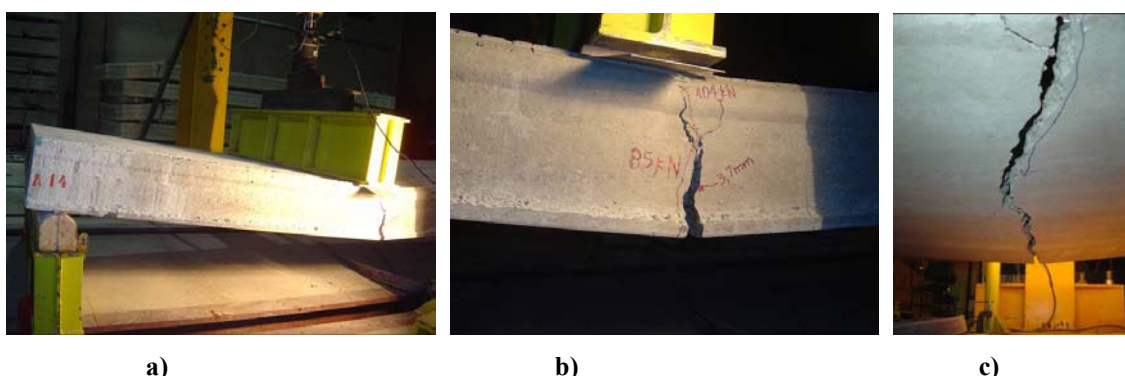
Configuração de fissuração da laje L14-20-SC-7_C: a) Aplicação de carga na laje a 5,75.h do apoio; b) Fissuração da parte lateral (lado direito); c) Fissuração da parte inferior da laje.
